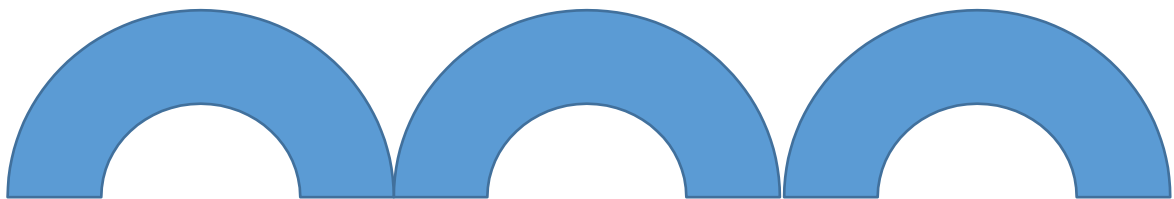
Vista esquemática em planta do assentamento em leque.
